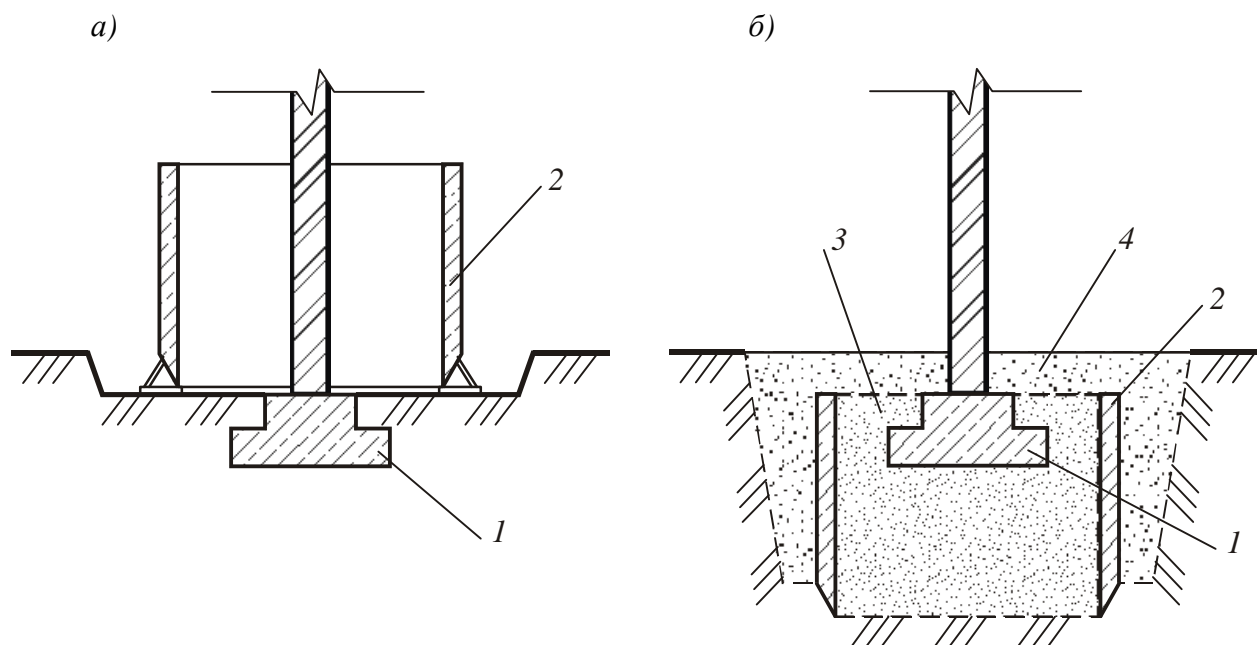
Усиление фундамента с помощью опускного колодца:
